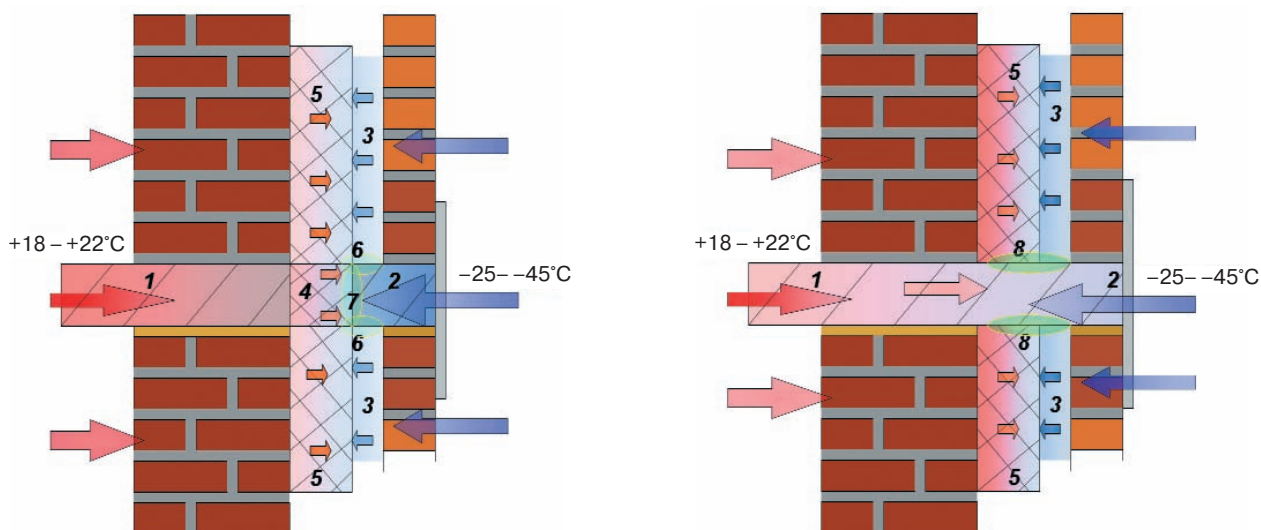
Сечение стены и перекрытия с теплоизолирующей вставкой (а) и без вставки (б): 1, 2 – плита перекрытия; 3 – воздушный зазор; 4 – теплоизолирующая вставка (МВП); 5 – утеплитель стены; 6, 7, 8 – зона контакта бетона и утеплителя
